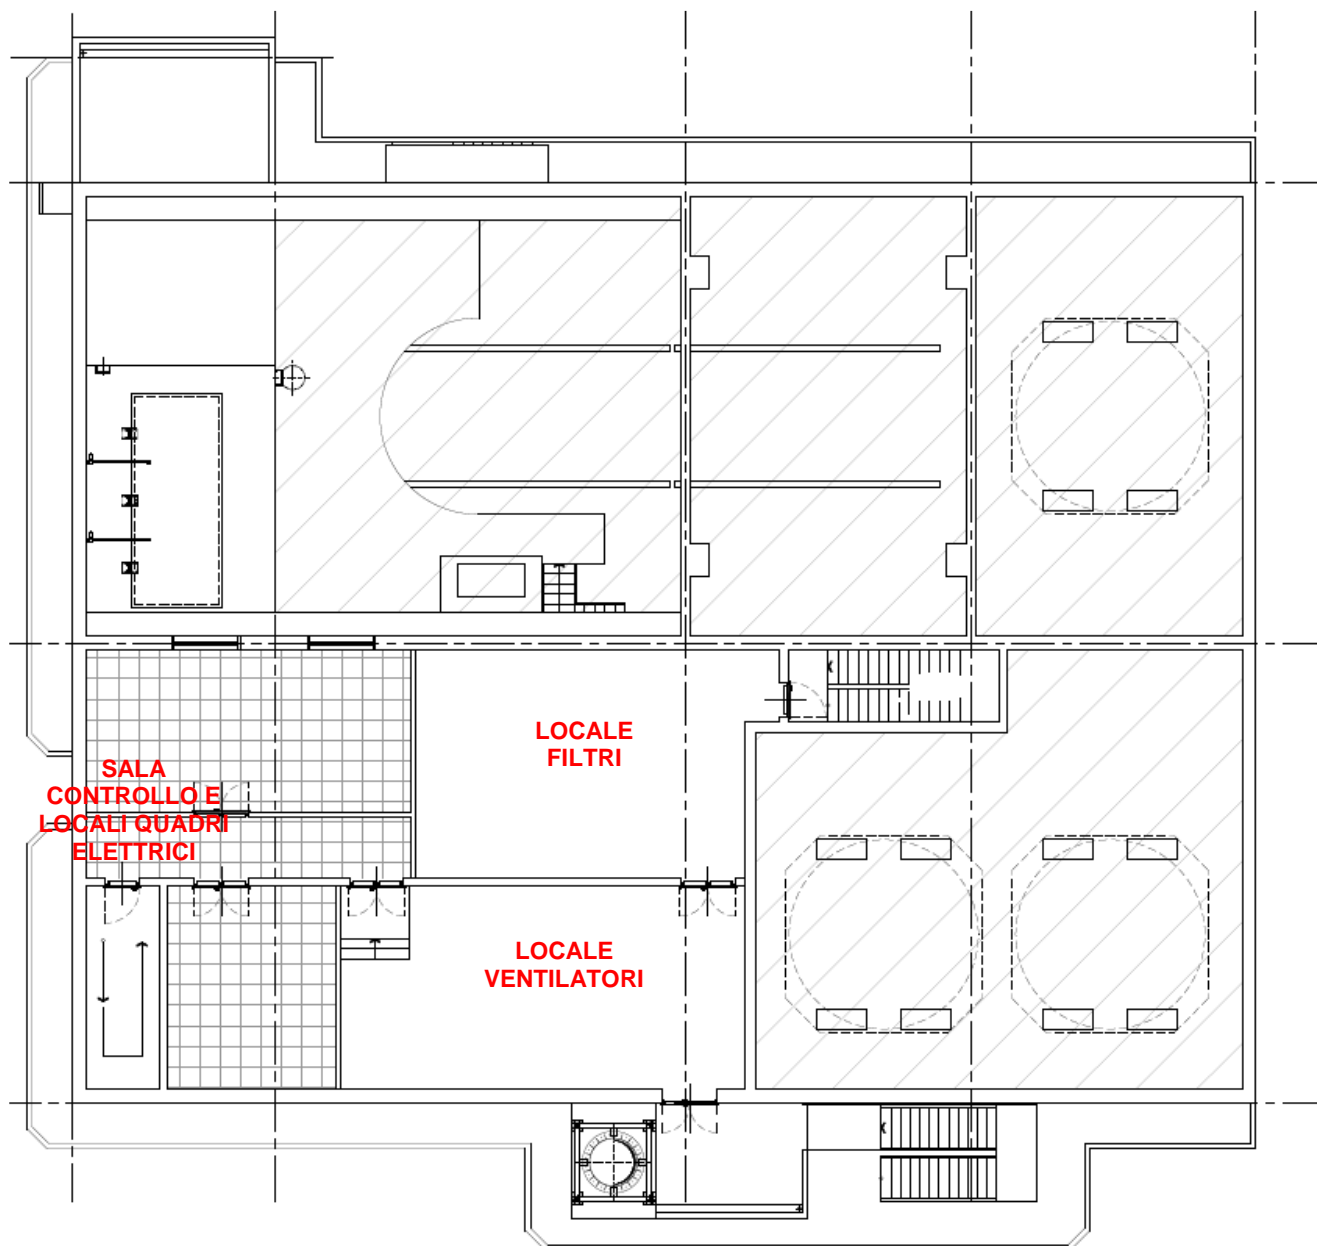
Stazione Trattamento Materiali – Pianta Primo Piano
